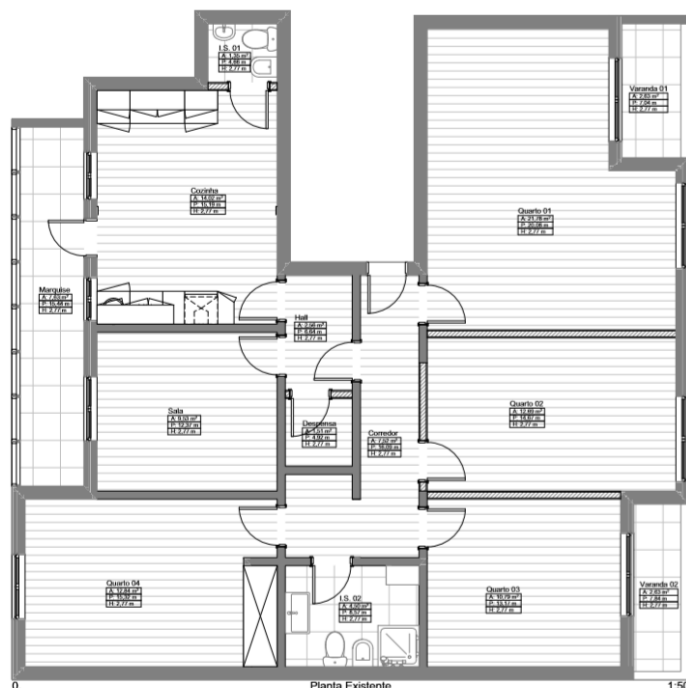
Planta do existente. Fonte: Biblioteca atelier
